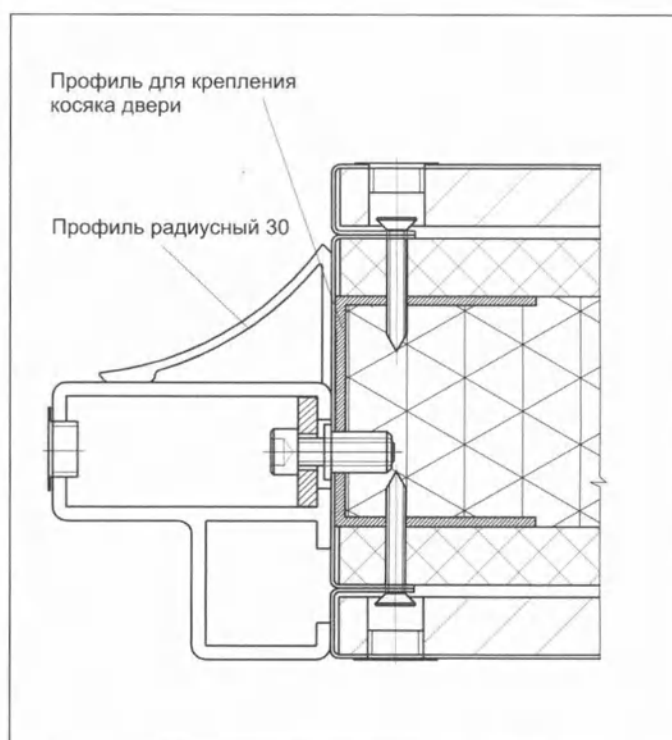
Способ нестандартного крепления профиля косяка до гипсокартоновой перегородки с облицовкой INWALL SYSTEMS®
